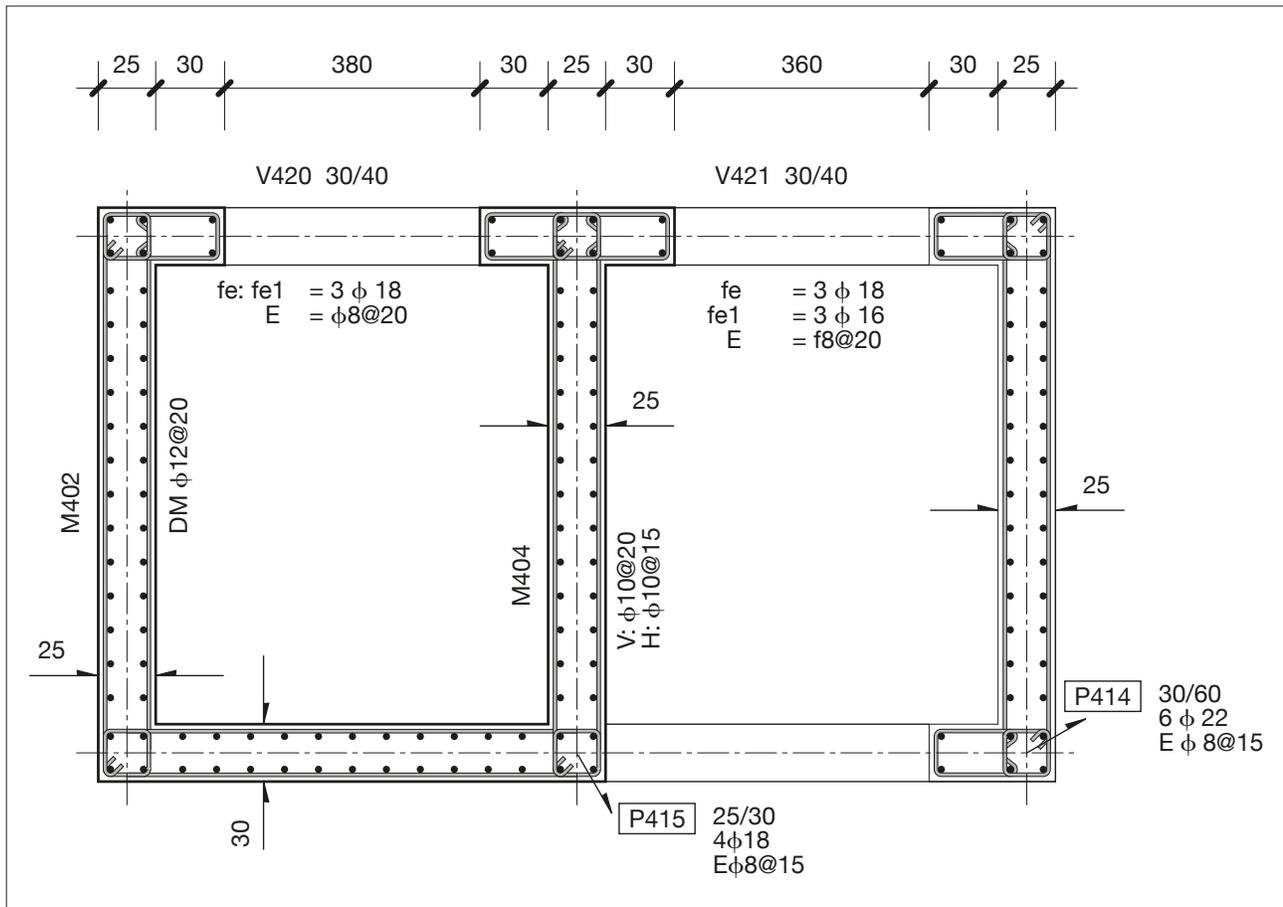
Plano de Conjunto Vigas, Columnas y Muros (fuera de escala).
